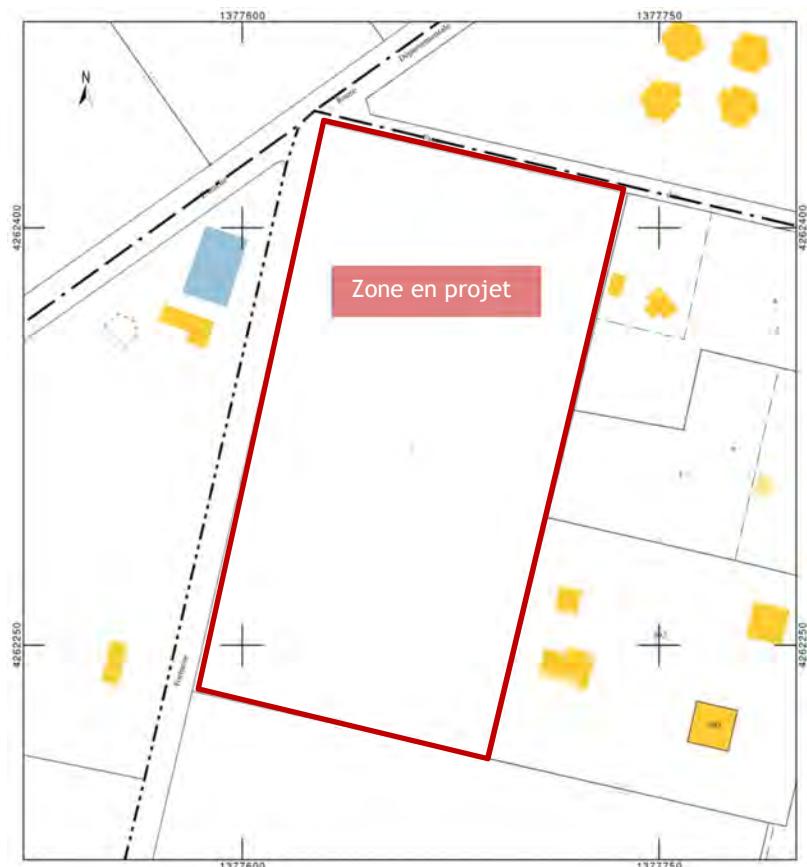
Plan cadastral du projet - Soulac sur Mer
